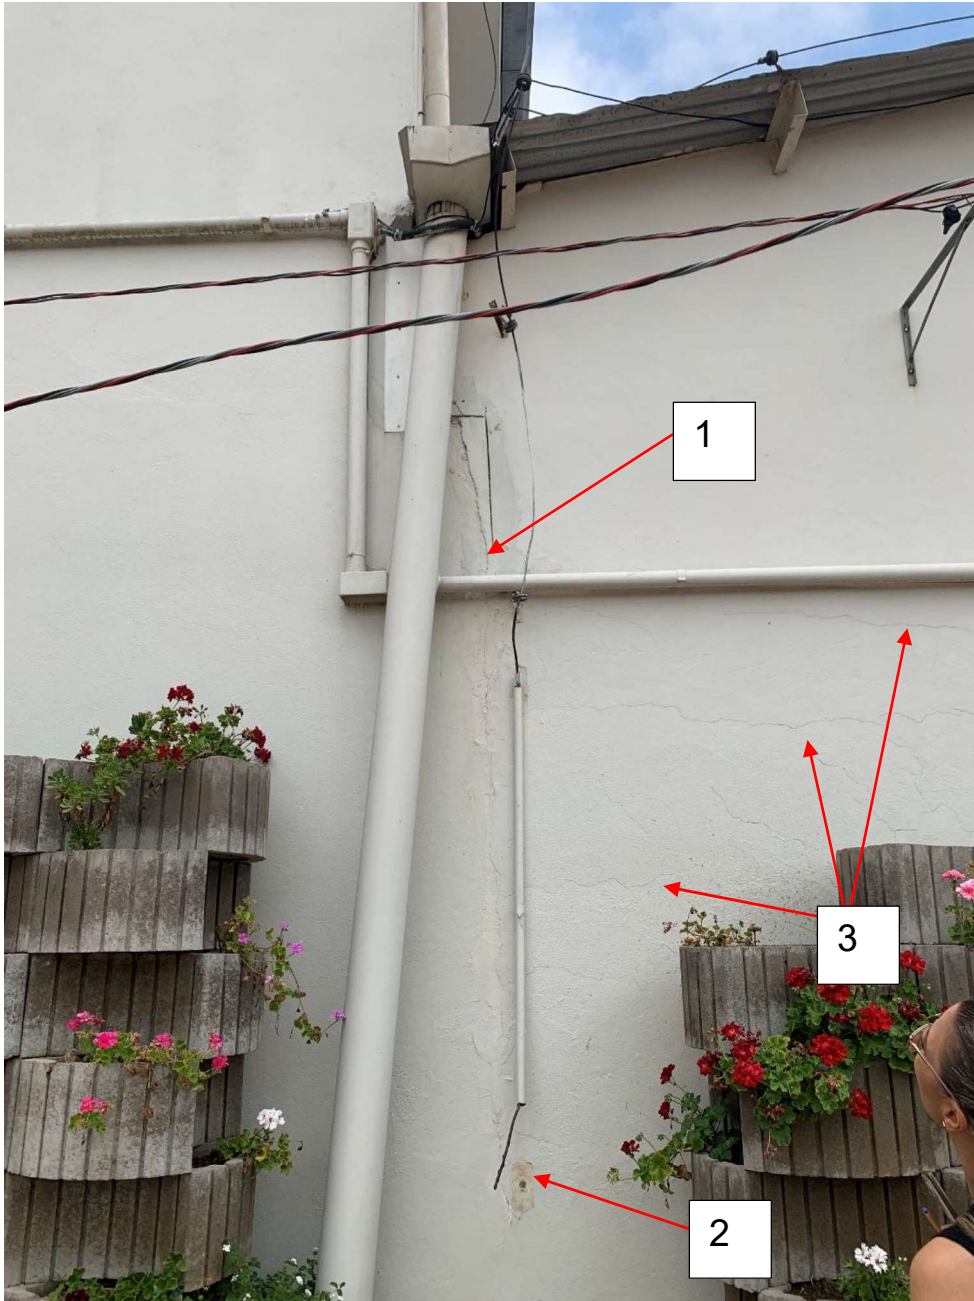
Vista externa, fundos da edificação, onde observa-se fissuras nas paredes, indicação 1, tubulação de coleta de água de chuva do telhado danificada, indicação 2.
